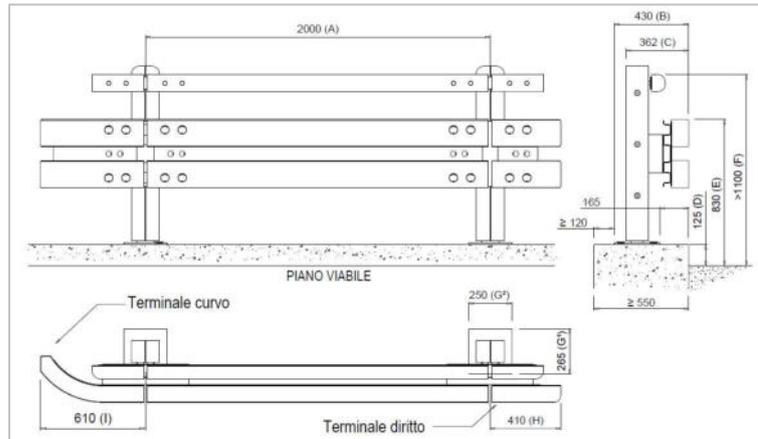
Pianta, prospetto e sezione tipo della barriera H2 BP in legno e Corten
